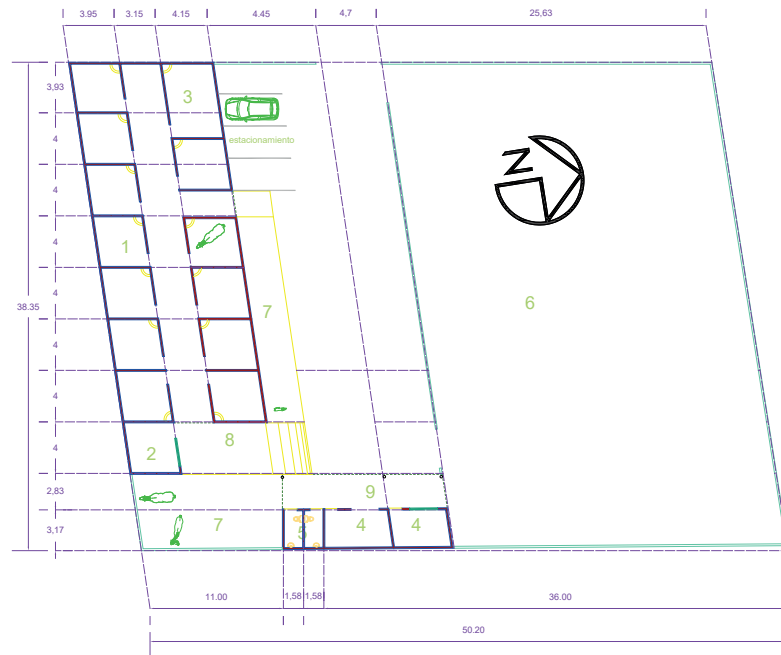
planta arquitectónica 1,900m² elaboración Noel Emmanuel Guzmán Zepeda.
